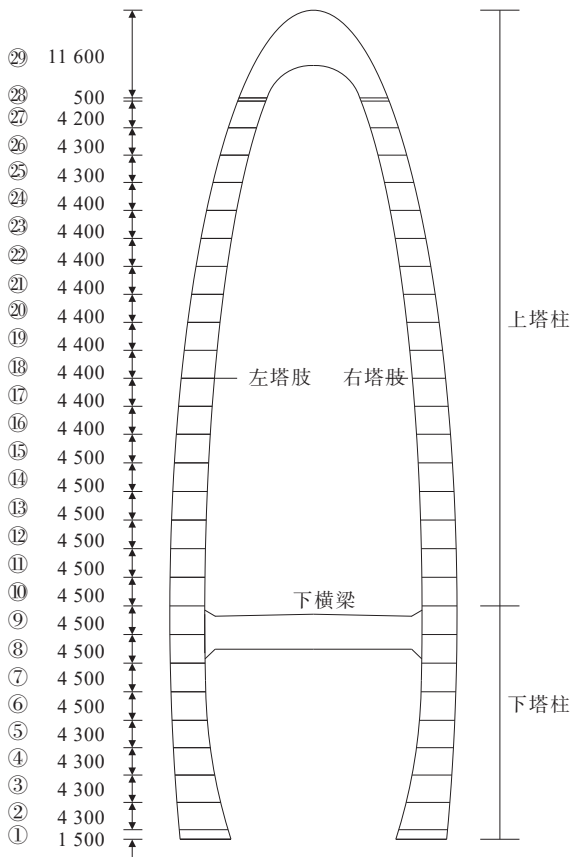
桥塔平面布置及施工阶段划分图(单位:cm)
